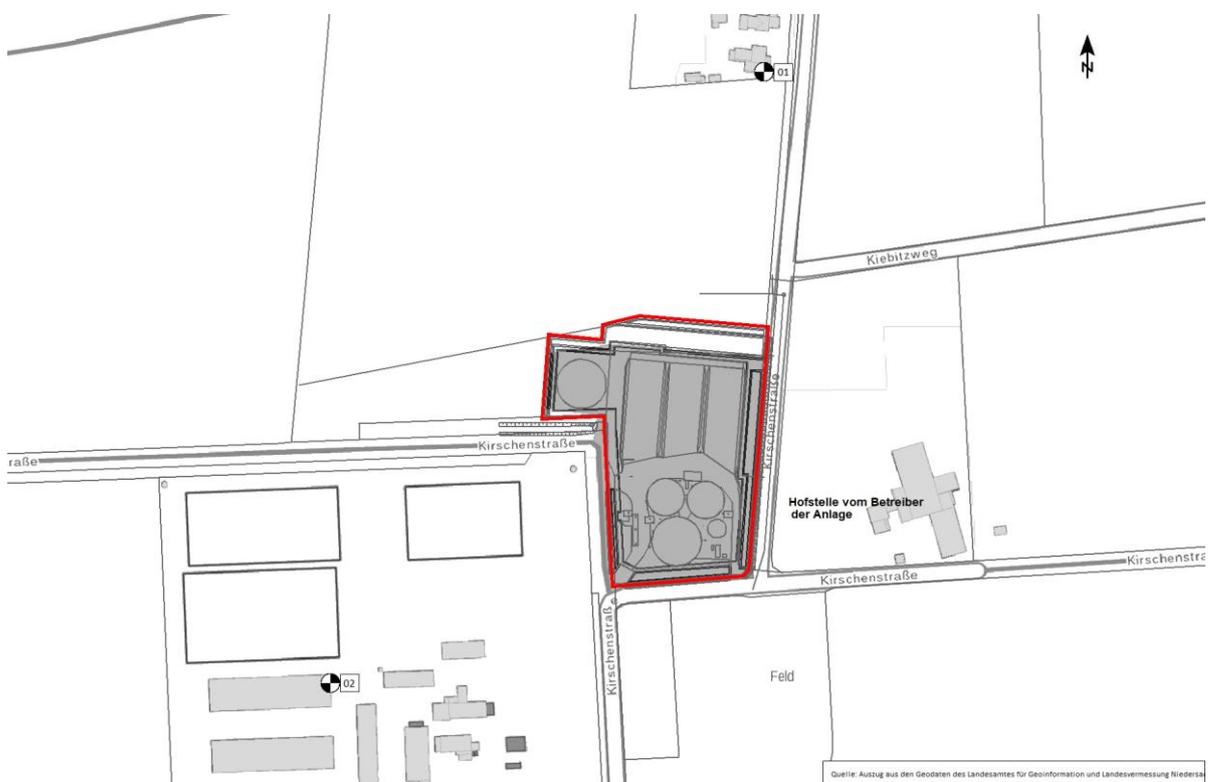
Übersichtslageplan mit Darstellung der betrachteten Immissionsorte
